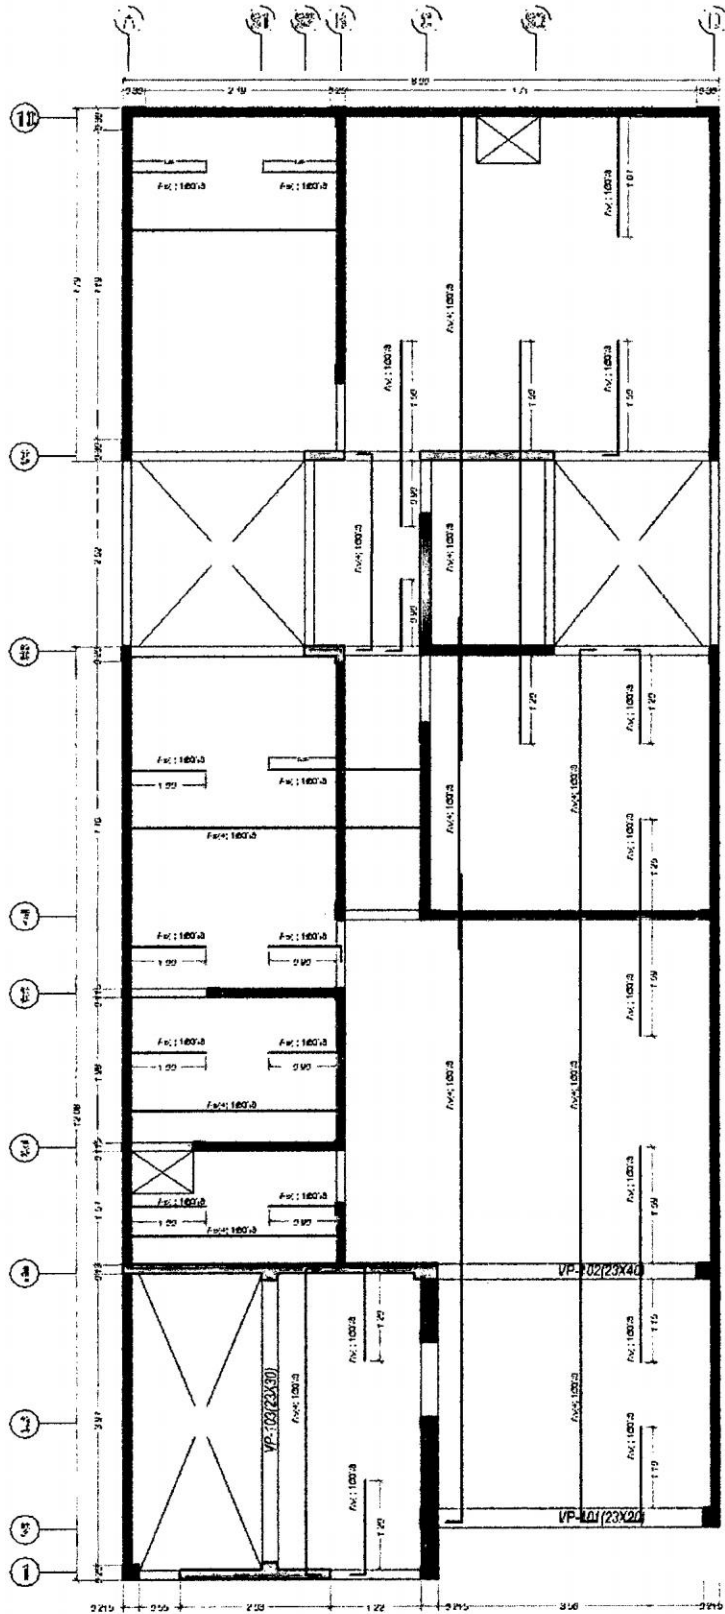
Distribución de acero en las viguetas de la losa aligerada
